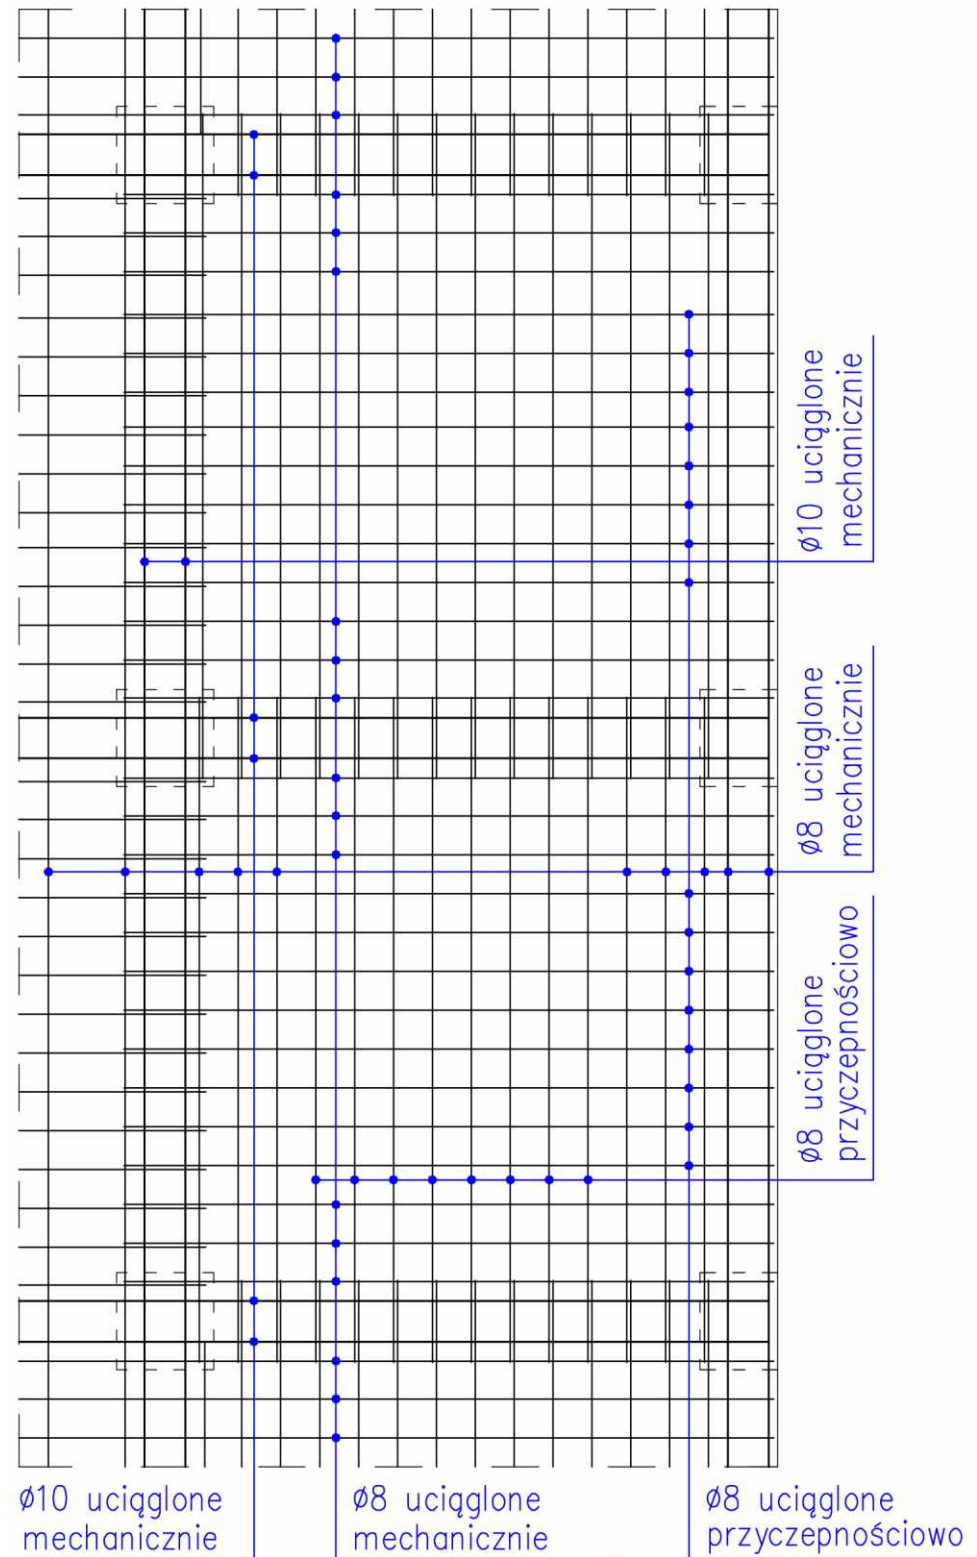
Zaprojektowane rozmieszczenie wkładek zbrojenia górnego (strefa krawędziowa i narożna)
